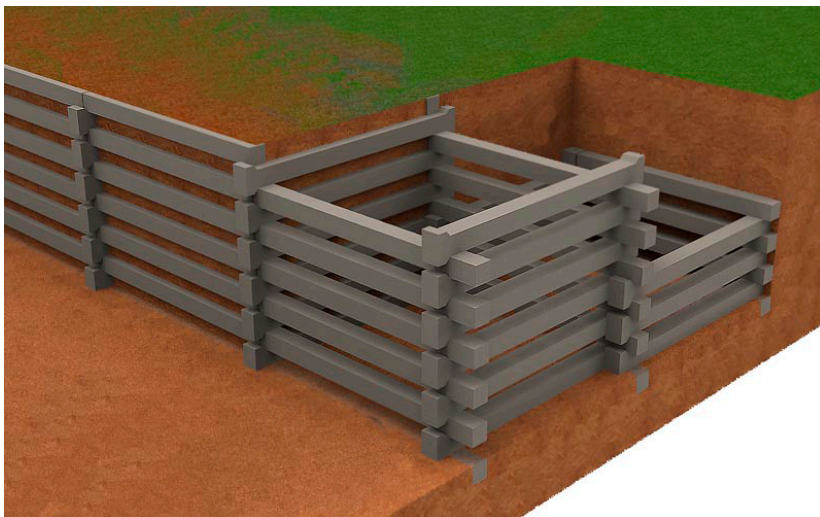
Сборная железобетонная подпорная стена ряжевого типа
